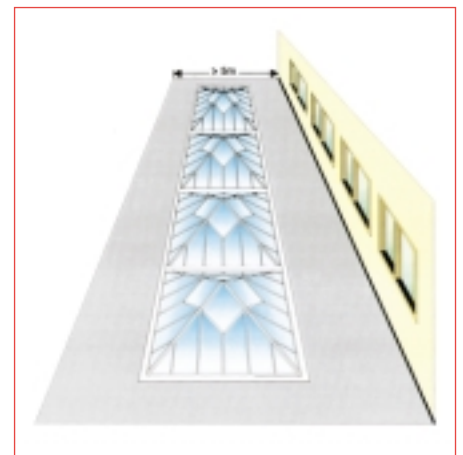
Erhöhter baulicher Brandschutz bei Variante Dachverglasung
